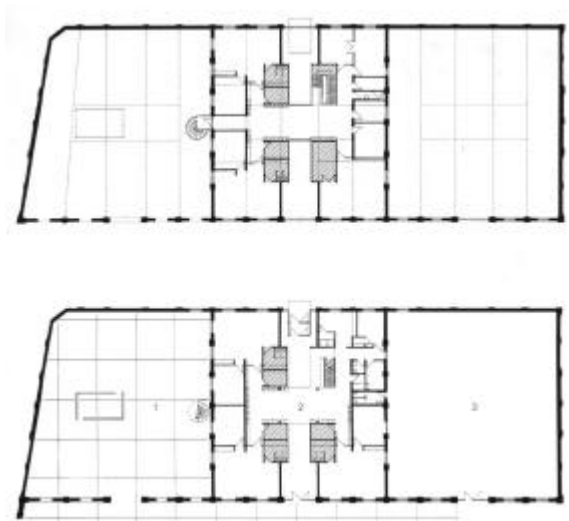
Grundrisse von Ober- und Erdgeschoß³
